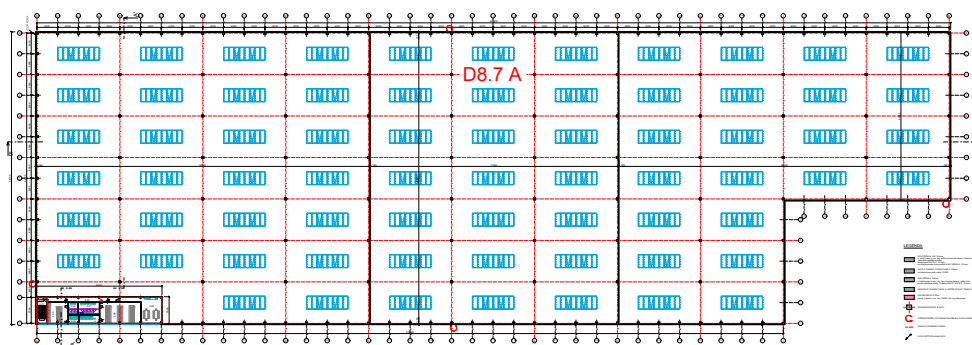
Hala D8-7A půdorys 1.NP výřezy [14]
